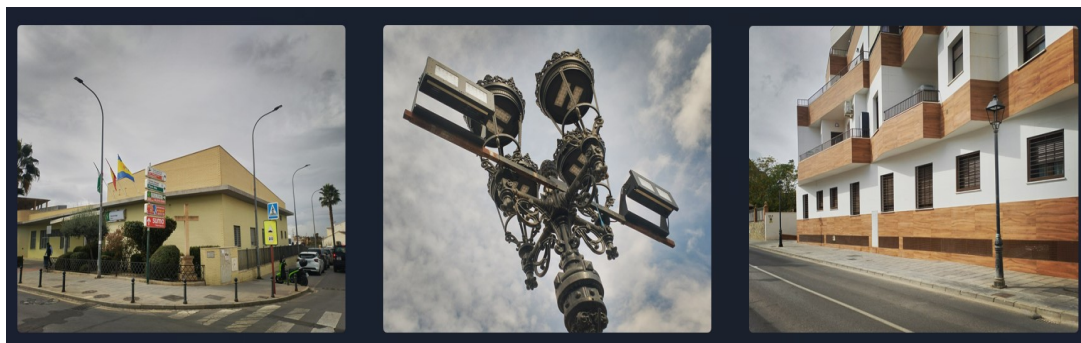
Nuevo Conjunto iluminación frente a Edificio Ayuntamiento.
